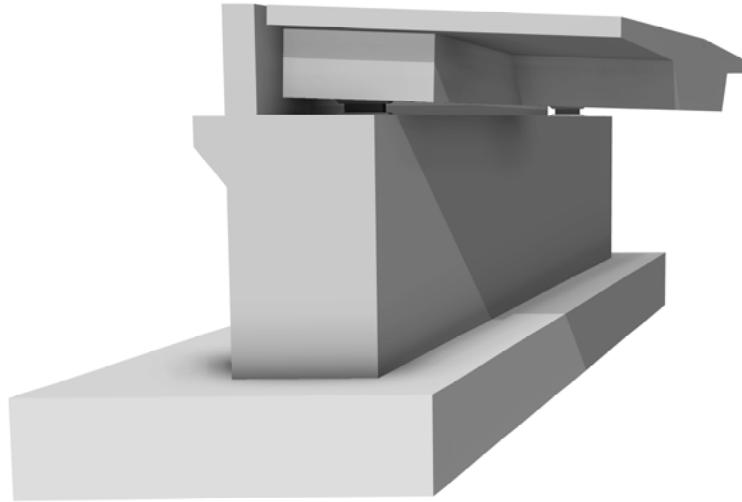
Estribo esviado de un puente con pendiente longitudinal.
